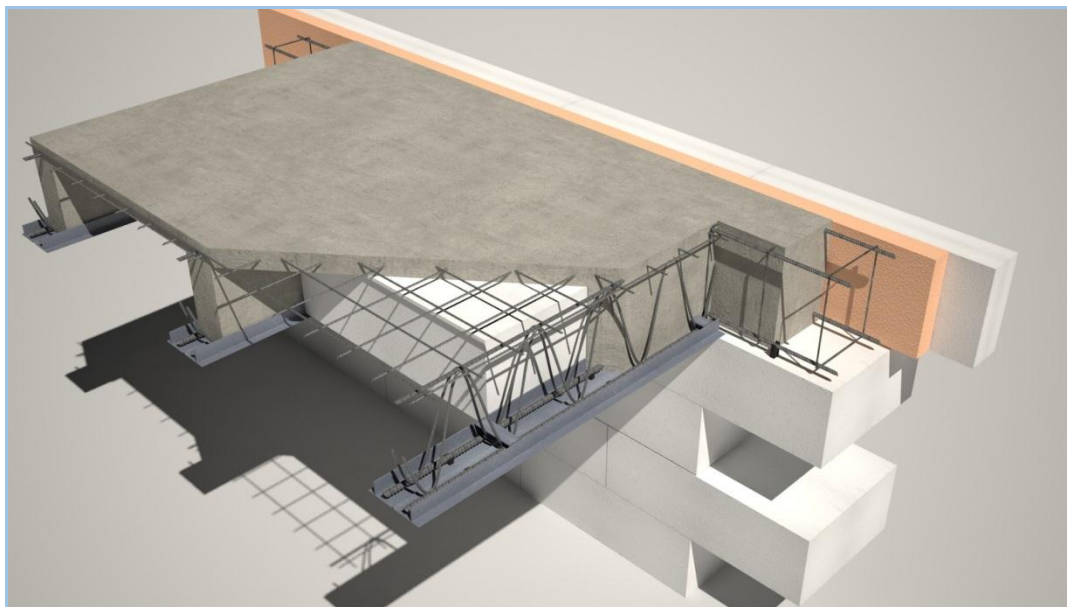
Сборно-монолитное перекрытие МАРКО-ГАЗОБЕТОН
